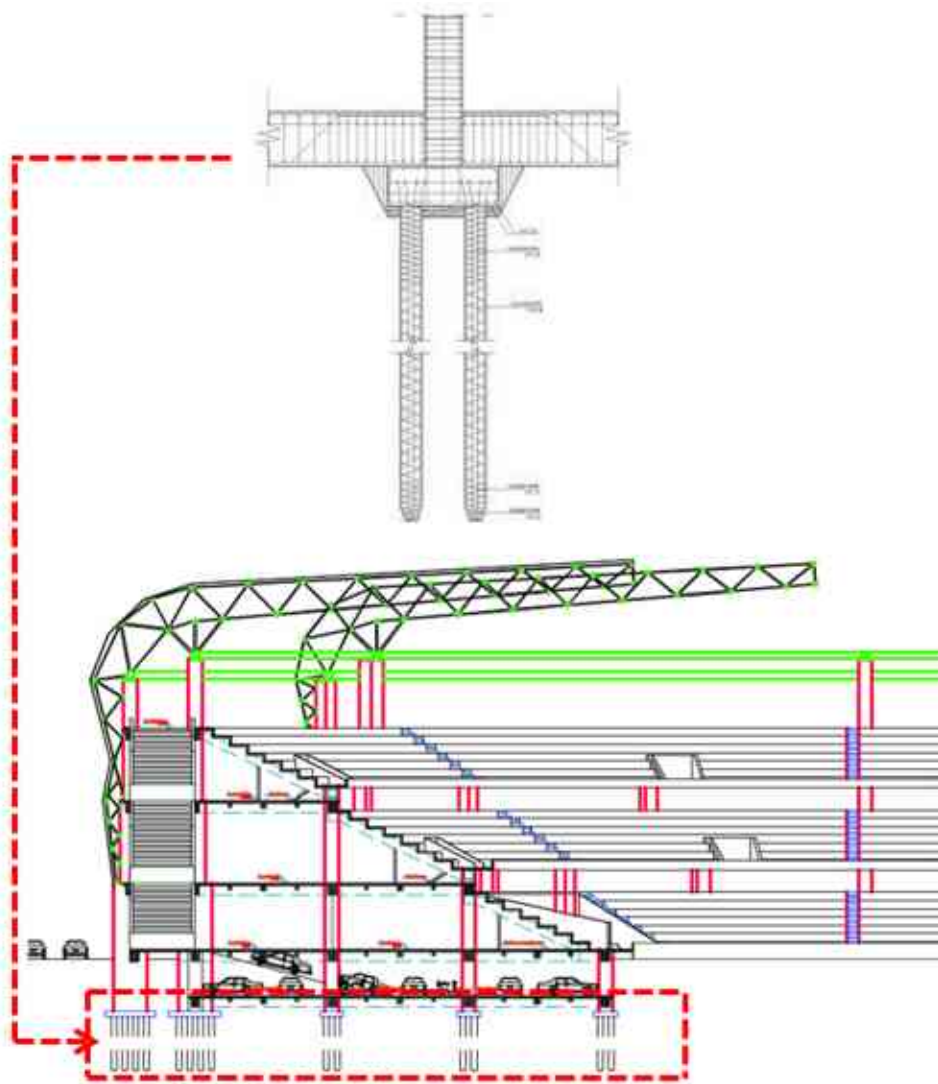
penerapan Struktur Rigid frame pada stadion
